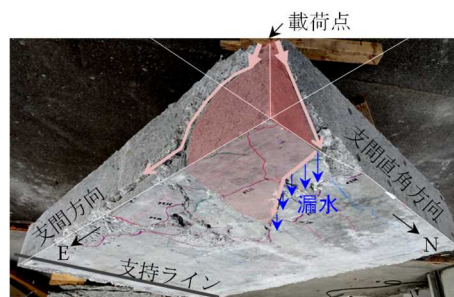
付着割裂ひび割れを伴うせん断ひび割れ（支間方向）と押し抜きせん断ひび割れ（支間直角方向）
